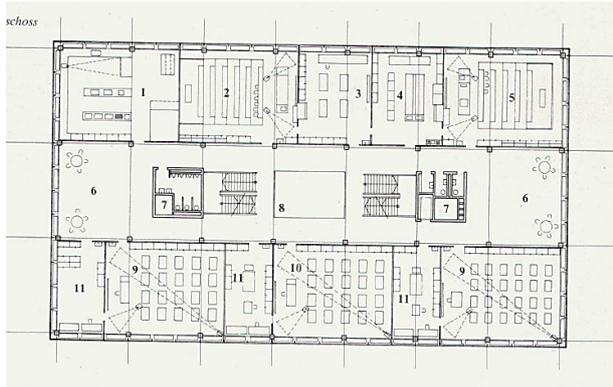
Klassentrakt 2, Grundriss 2. Obergeschoss
